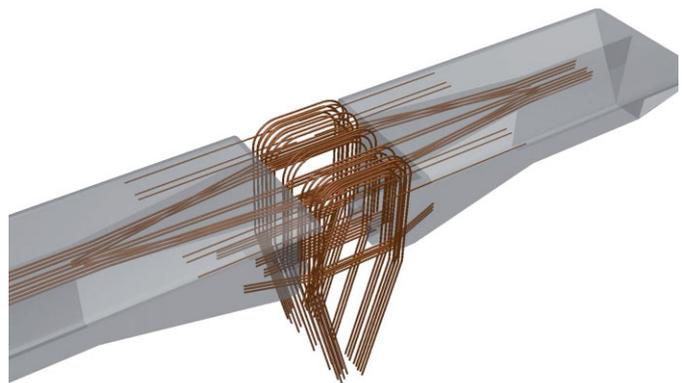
Rollbrücke Ost 1, Bewehrungsplanung Rahmenecke
